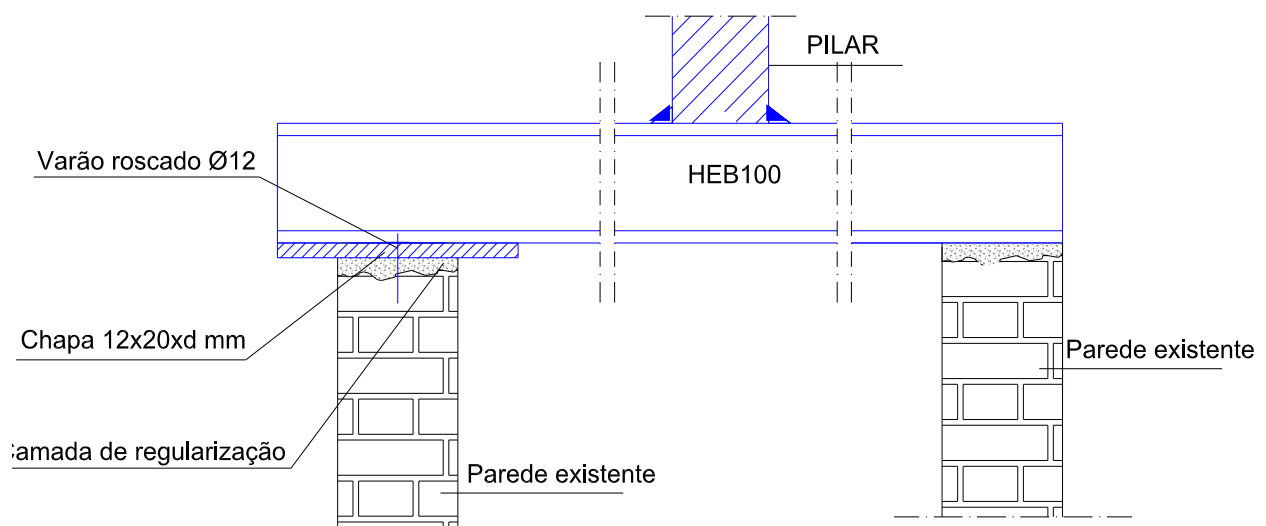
Ligação das vigas de fundação dos pilares à parede resistente (secção transversal)
